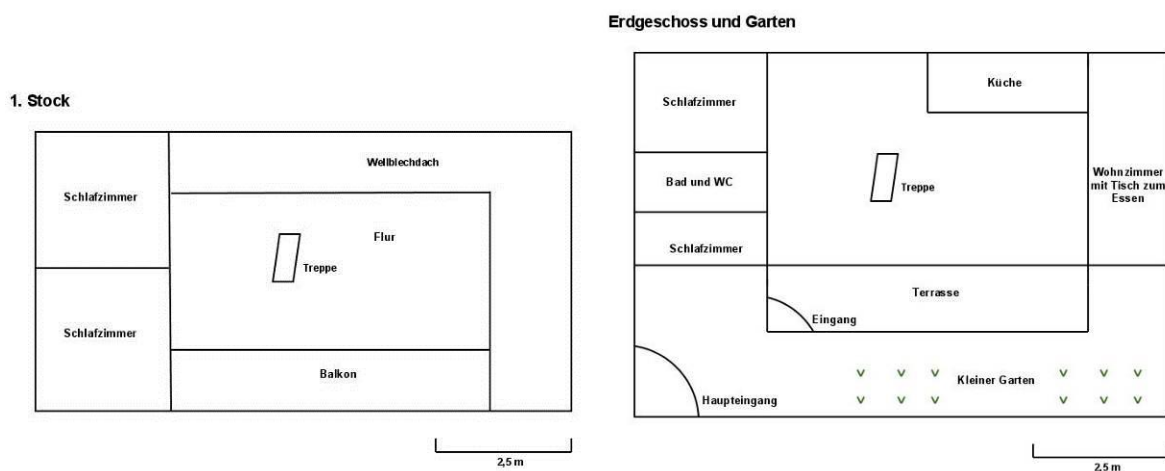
Grundriss des Wohnhauses.
